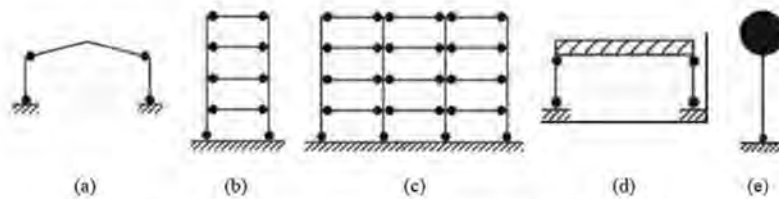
Configurazioni dissipative di strutture intelaiate: disposizione delle cerniere plastiche, secondo le tipologie esposte nella Tabella 7.3.II del § 7.3.1 delle NTC
